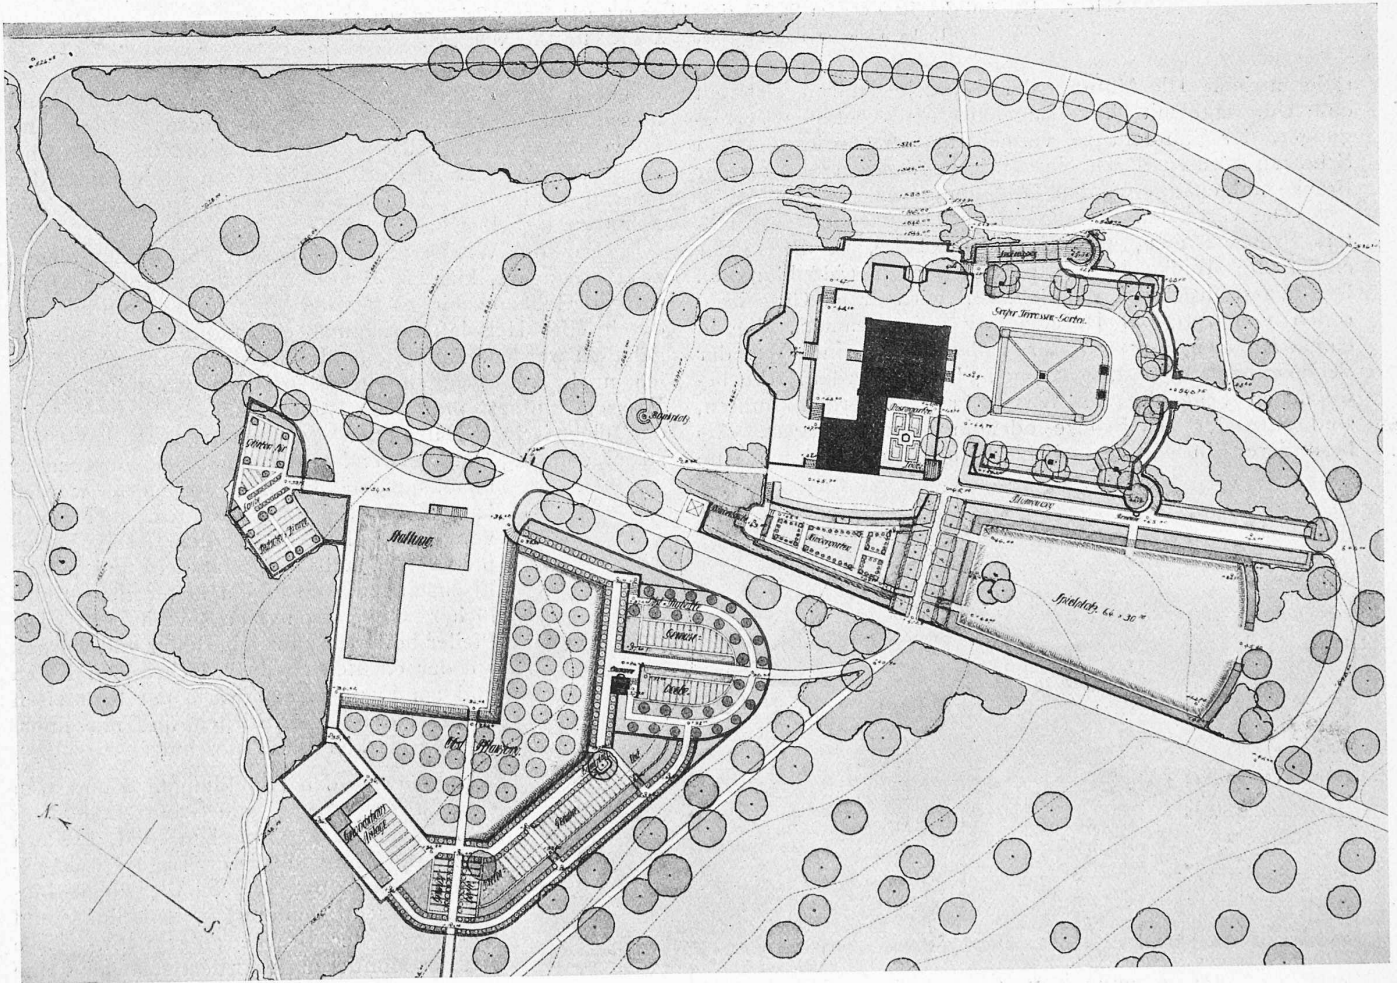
Landhaus Bocken bei Horgen. — Architekten *Streiff & Schindler* und Kunstgärtner *P. Schädlich*, Zürich. — Lageplan 1:1600.
